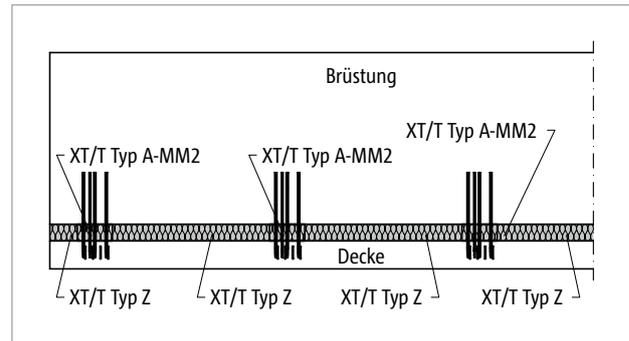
Schöck Isokorb® XT/T Typ A, Z: Brüstung (XT/T Typ A-MM2)
